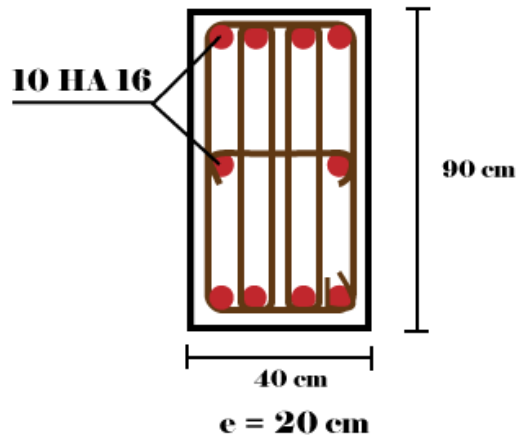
schéma de ferrailage des poutres de rigidité
